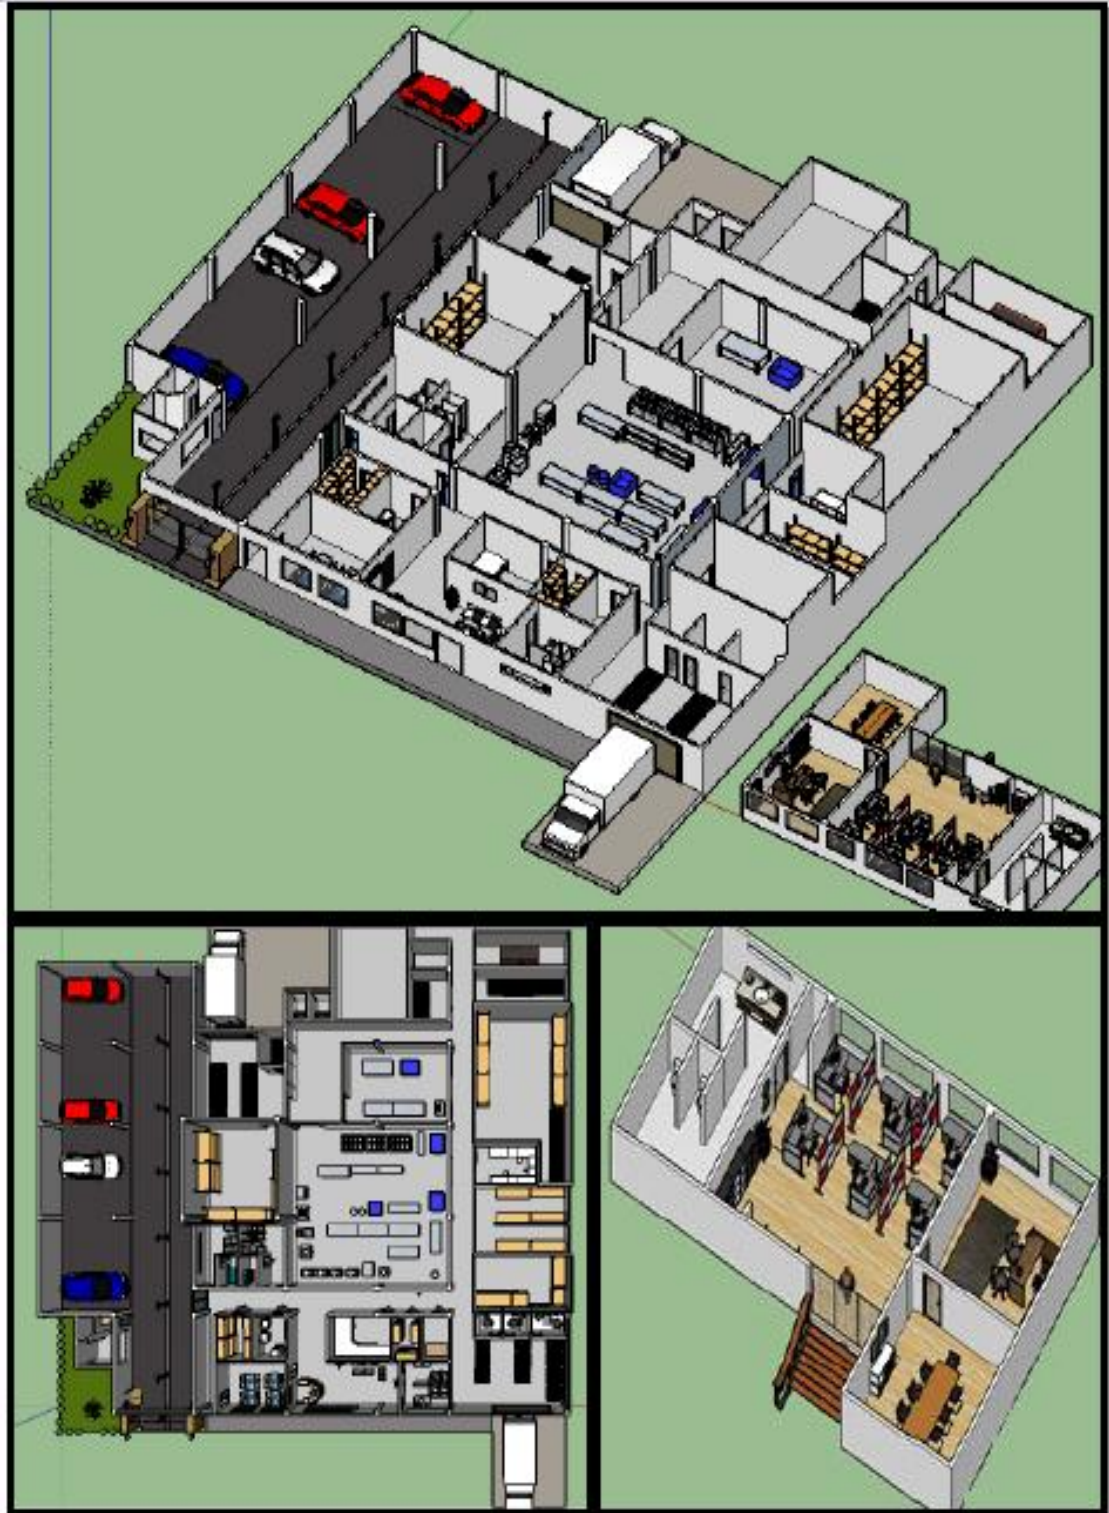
Plano de la primera y segunda planta del nuevo centro de producción de Marvilla S.A en SketchUp
